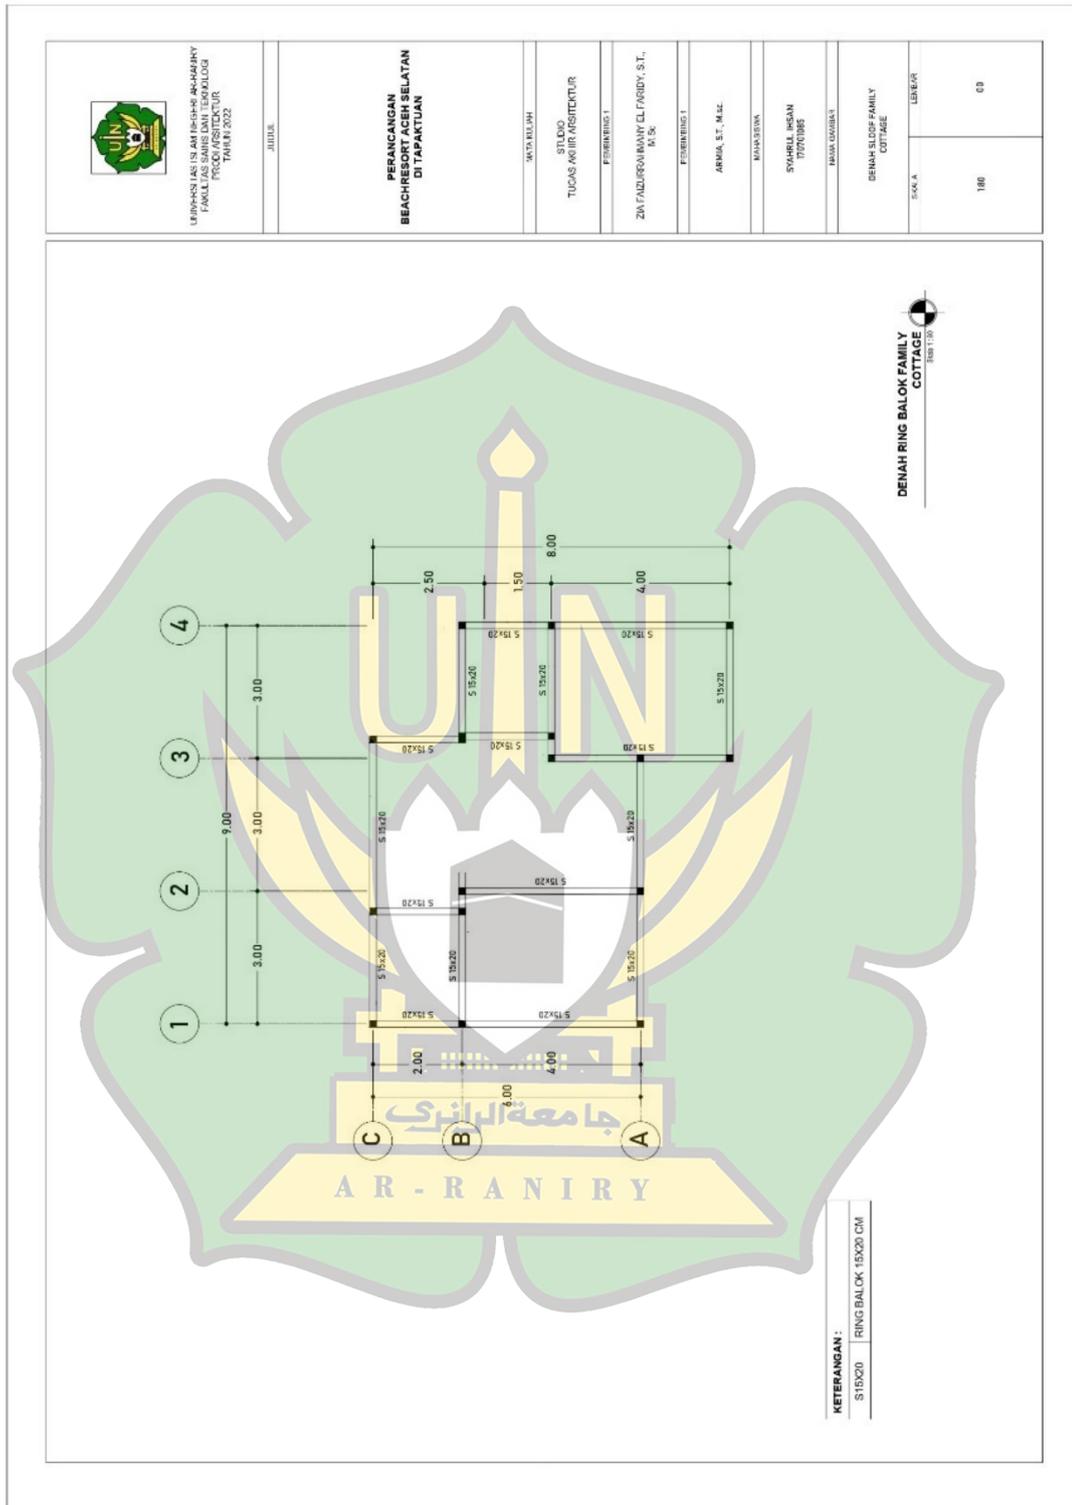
Detail Kolom, Balok, Sloof, Ring Balok
